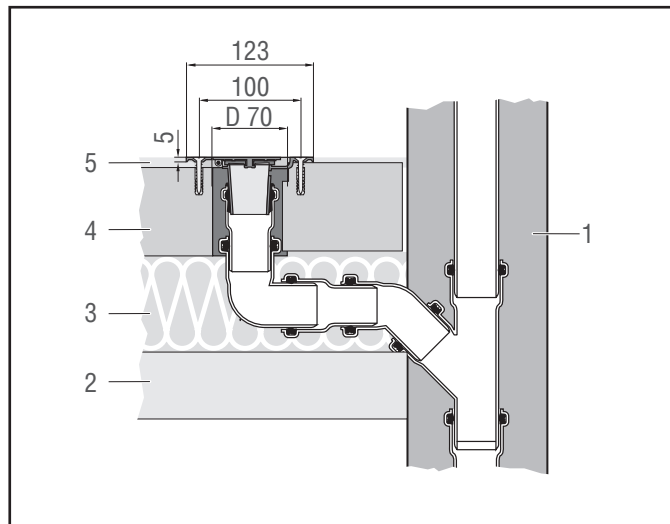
Схема монтажа при прокладке в слое теплоизоляции
